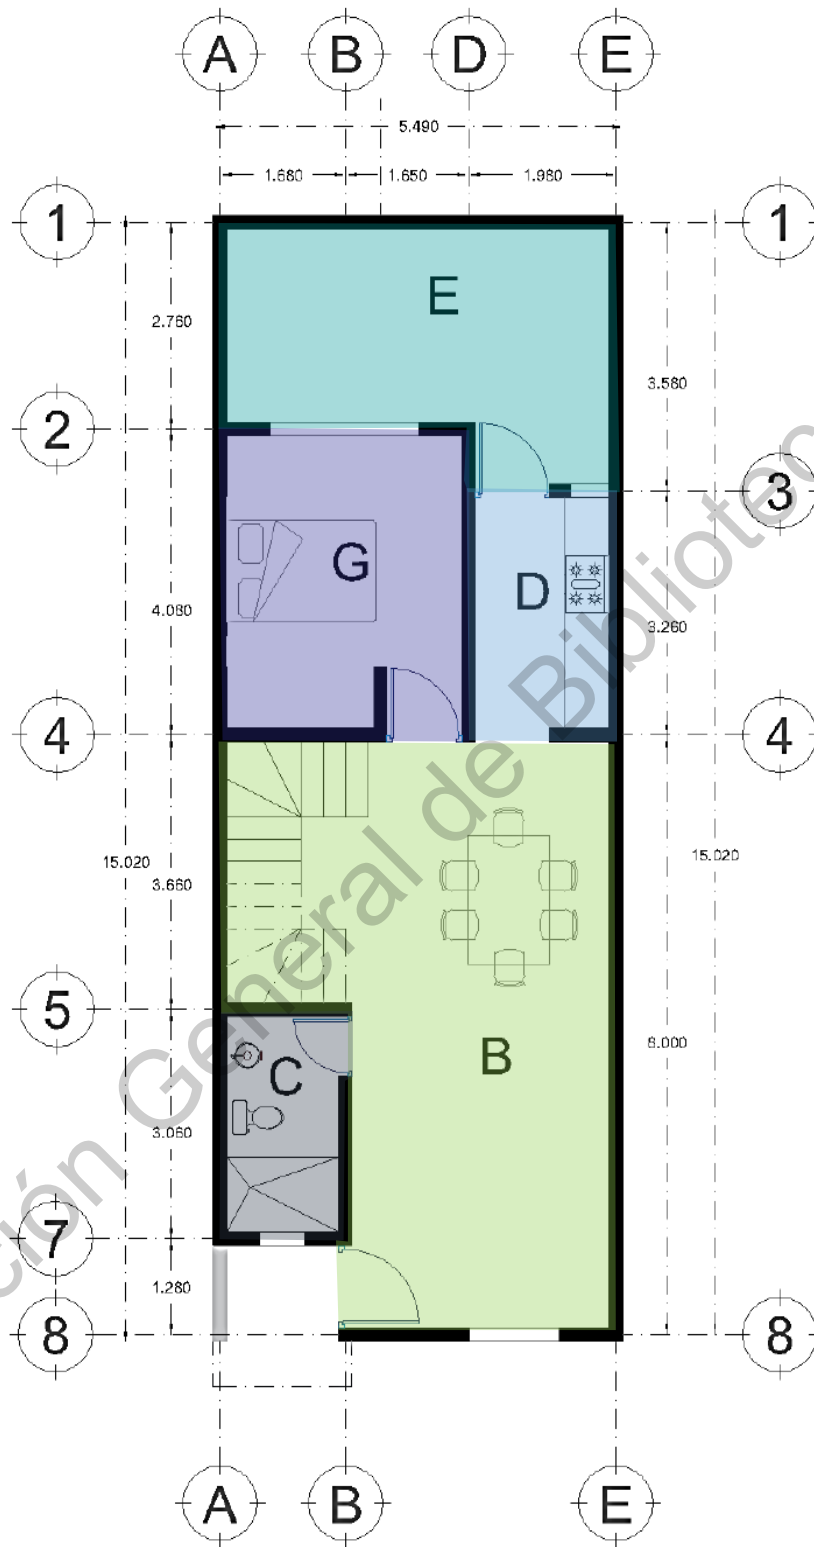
Planta Arquitectónica Baja. Casa Viñedos, Zonificación Ecotect
